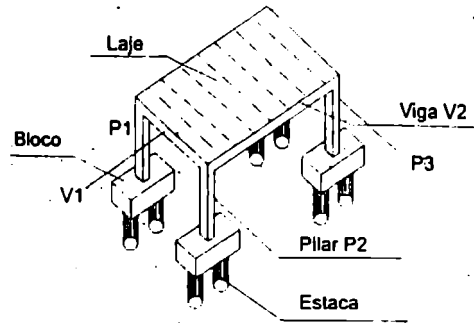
Edifício com estrutura em concreto moldado no local e seus elementos.
